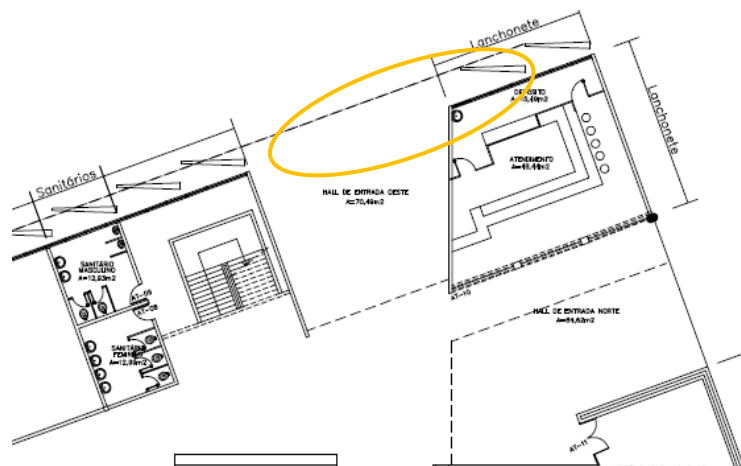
Detalhe de projeto da entrada do FA (CEPLAN - UnB, 2009)
